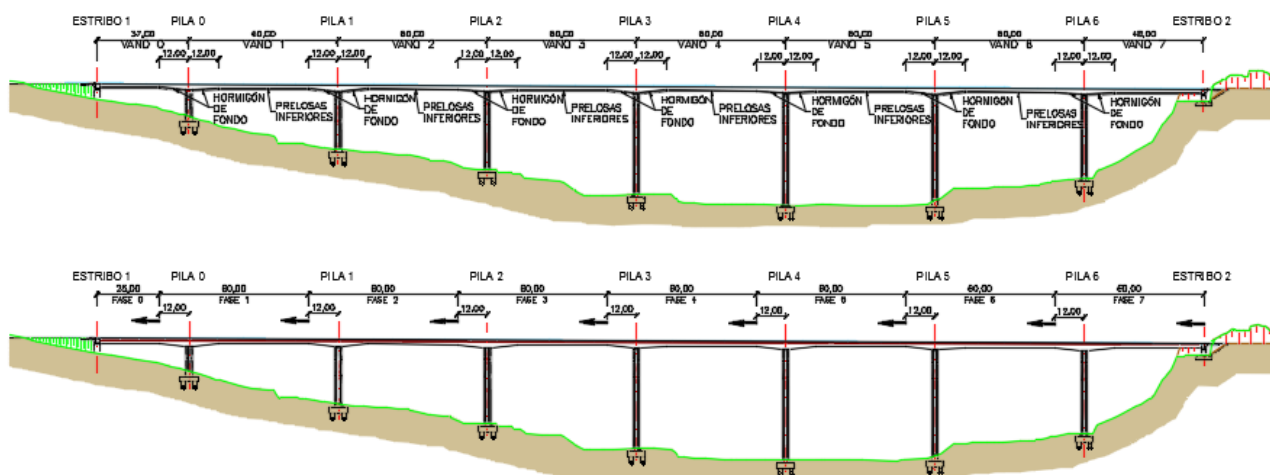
Proceso constructivo. Fase (1)-Pilares y cimentaciones y (2) Montaje de tramos metálicos.
